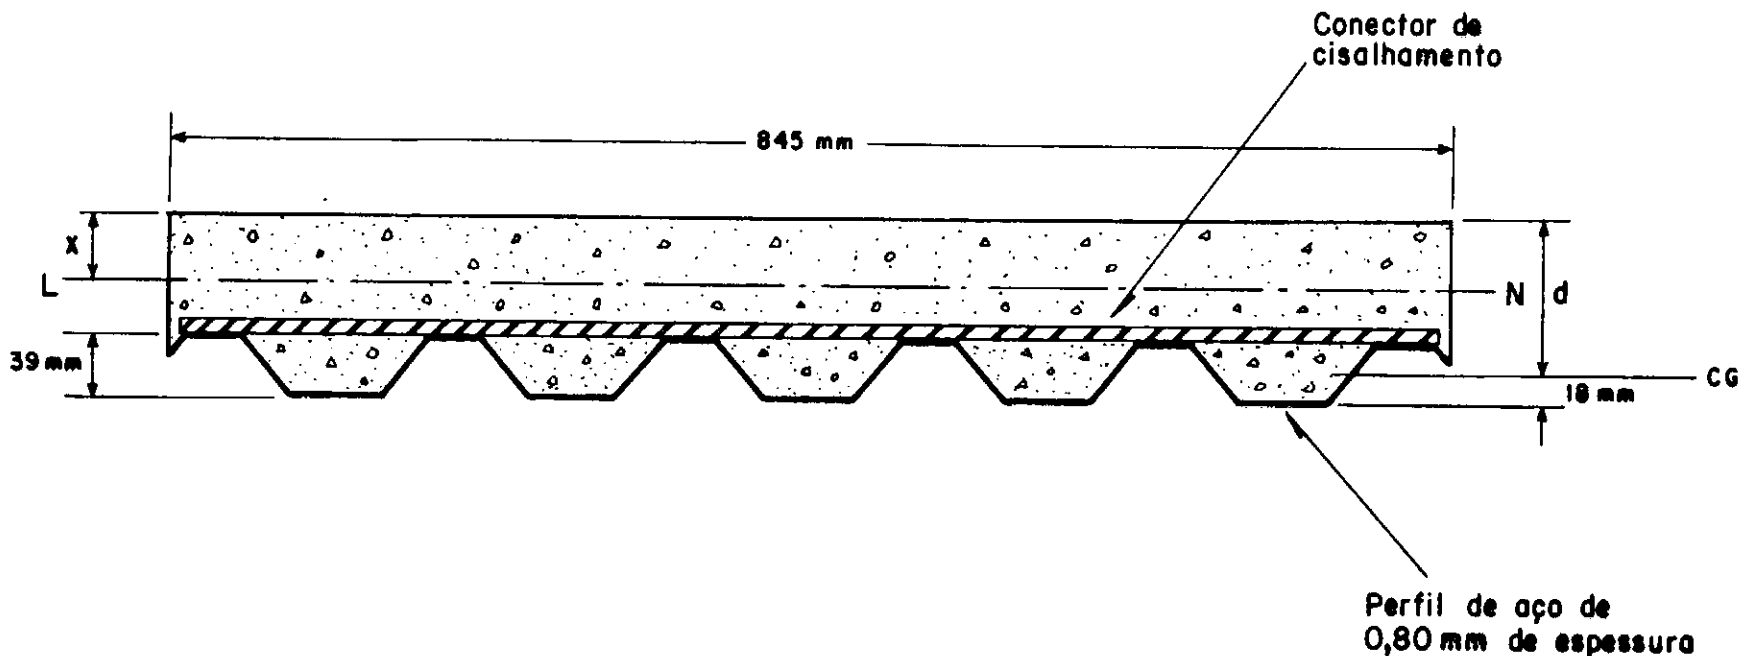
Geometria da secção transversal utilizando perfil RF-40 (ROLL-FOR).
